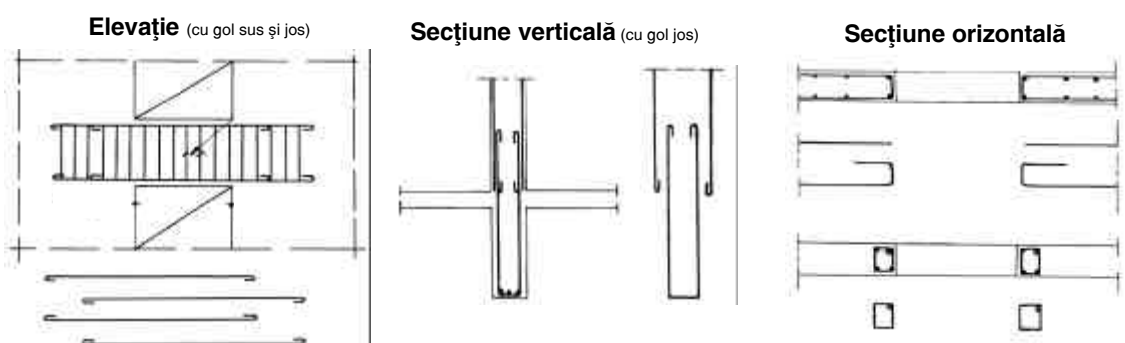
I.1 Clădiri cu structuri din pereți de beton armat monolit. Plan parter. Elevație diafragme. Detalii îmbinări.
